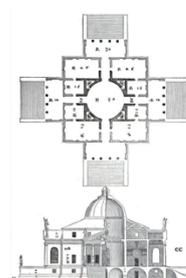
Architekturzeichnungen der "Villa La Rotonda". Grundriss und Aufriss zeigen die symmetrischen Anordnungen.
